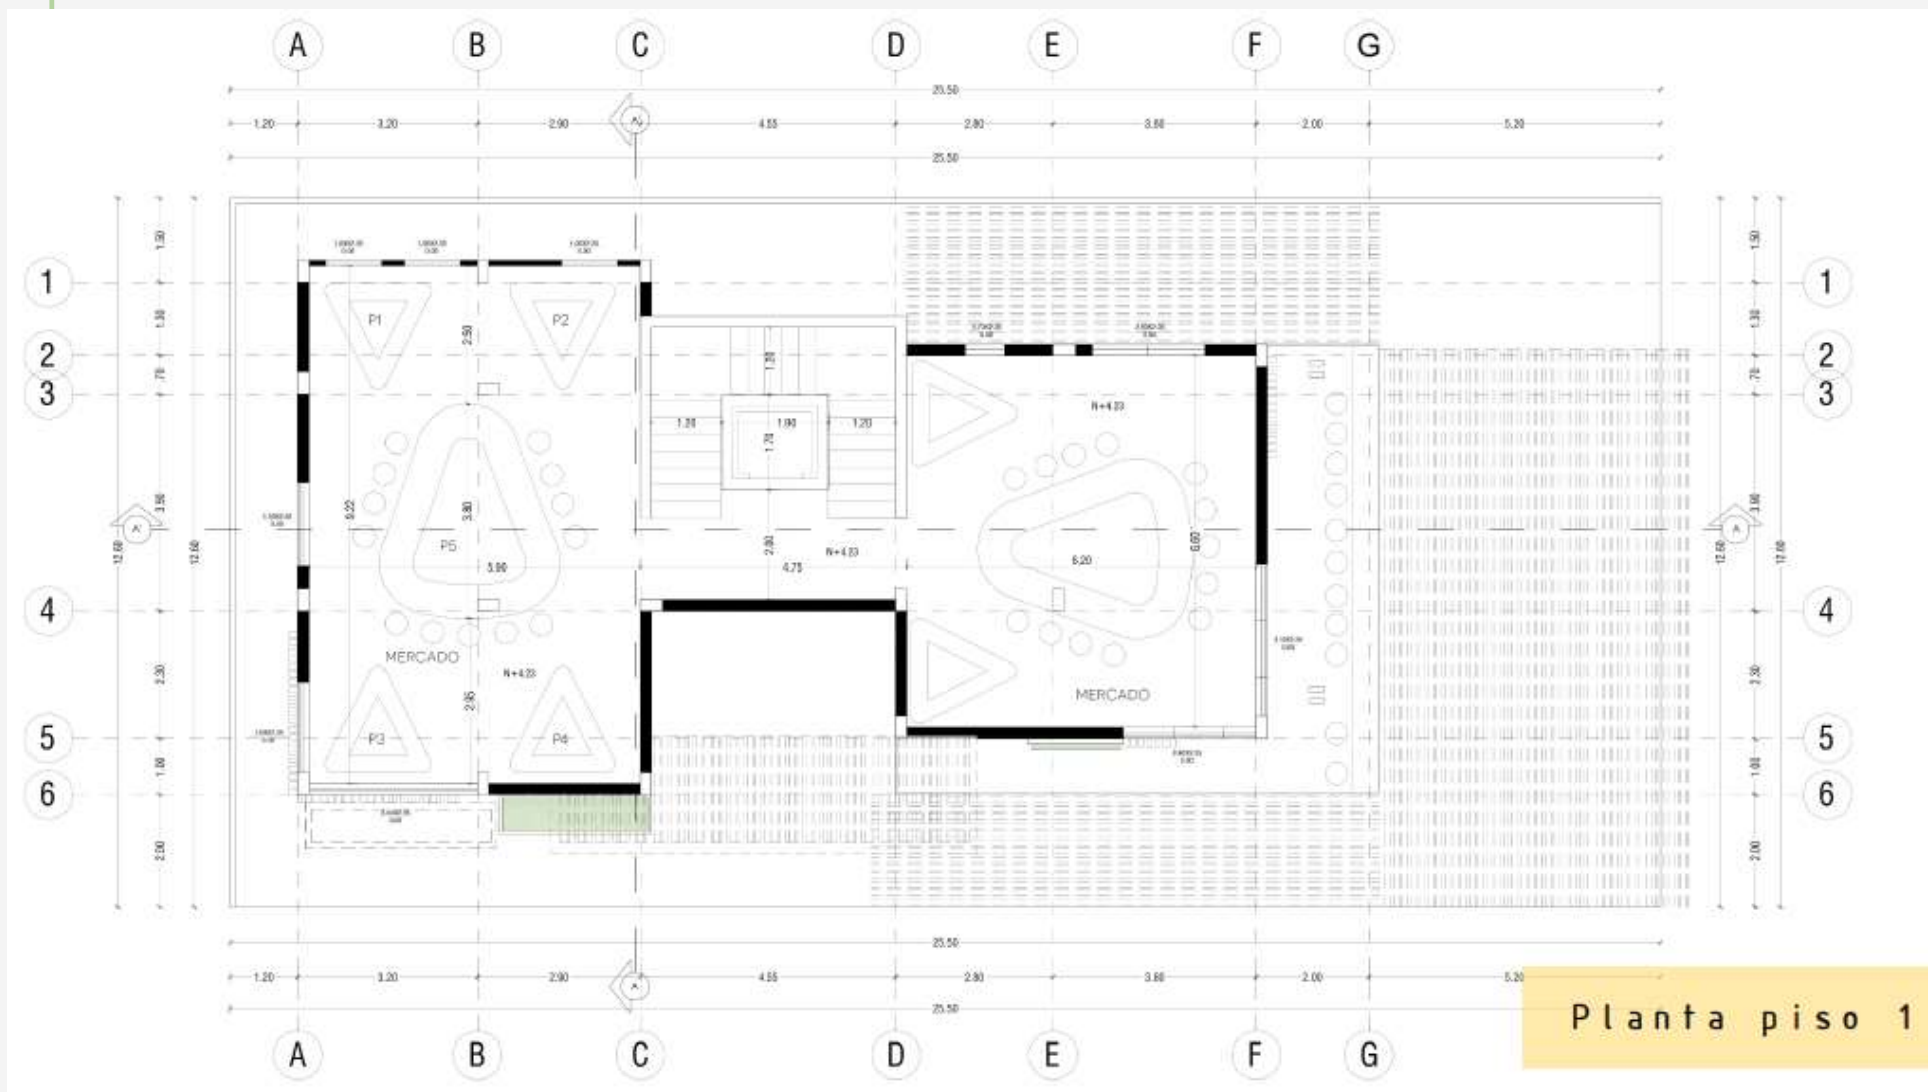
Planos arquitectónicos (P1). Fuente: Andrea Balcázar (2018)
